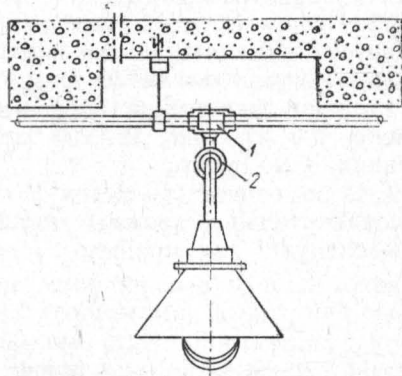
Подвеска трубопровода со светильником поперек балок:
